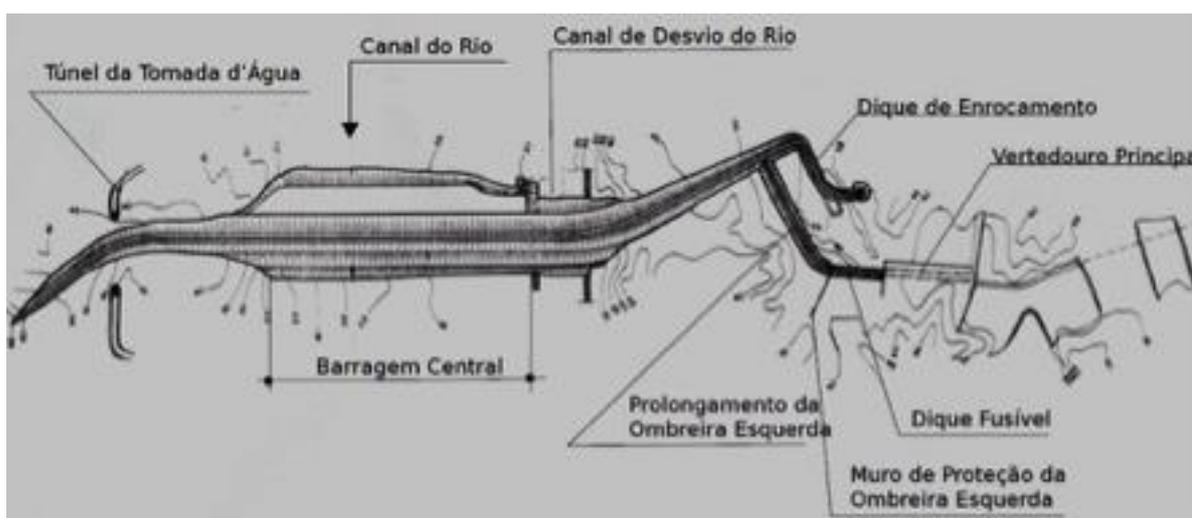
Planta Baixa da Barragem Armando Ribeiro Gonçalves e Vertedouros
